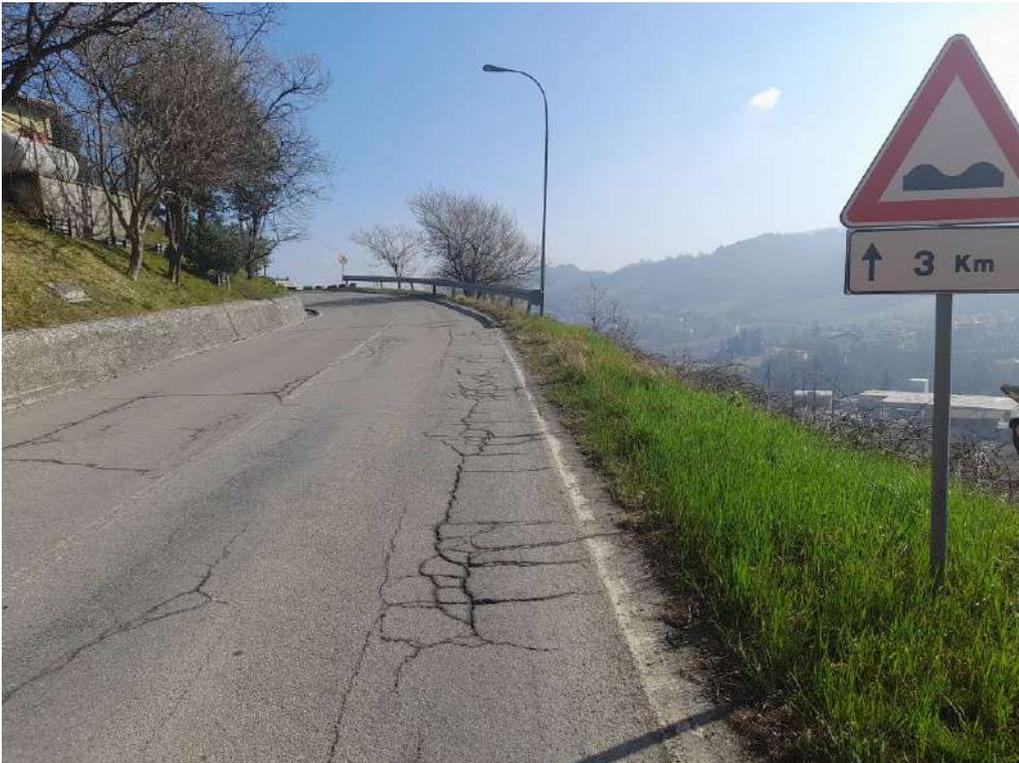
vista del tratto stradale oggetto di intervento e dei degradi della pavimentazione stradale
